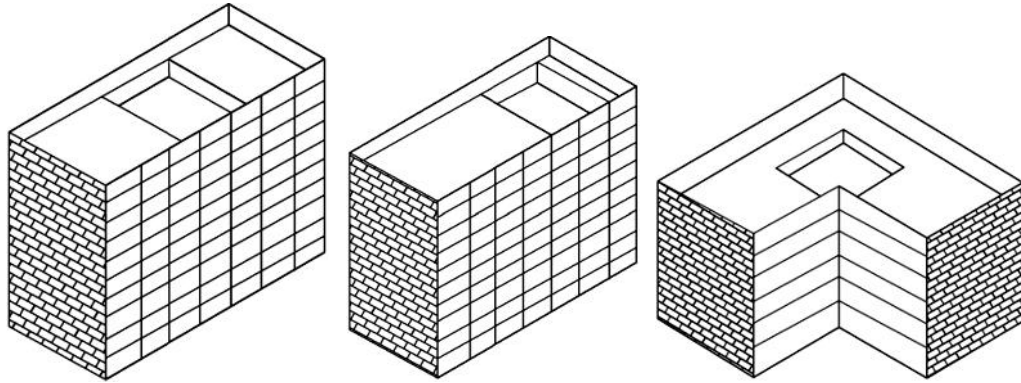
Aberturas inadecuadas en el sistema de piso y techo (Arnold y Reitherman, 1986).
